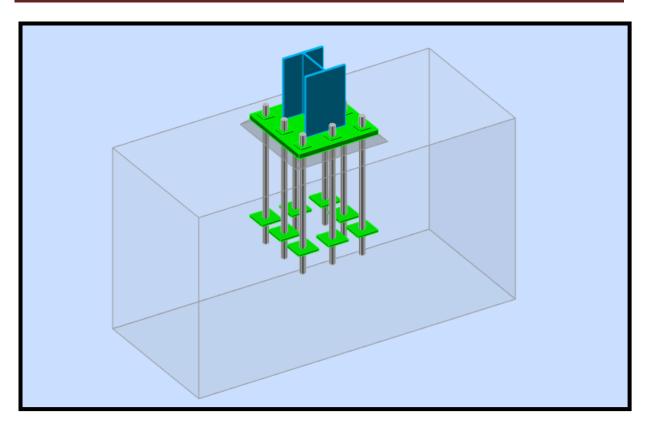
Vue d'assemblage pieds de poteau encastré.
